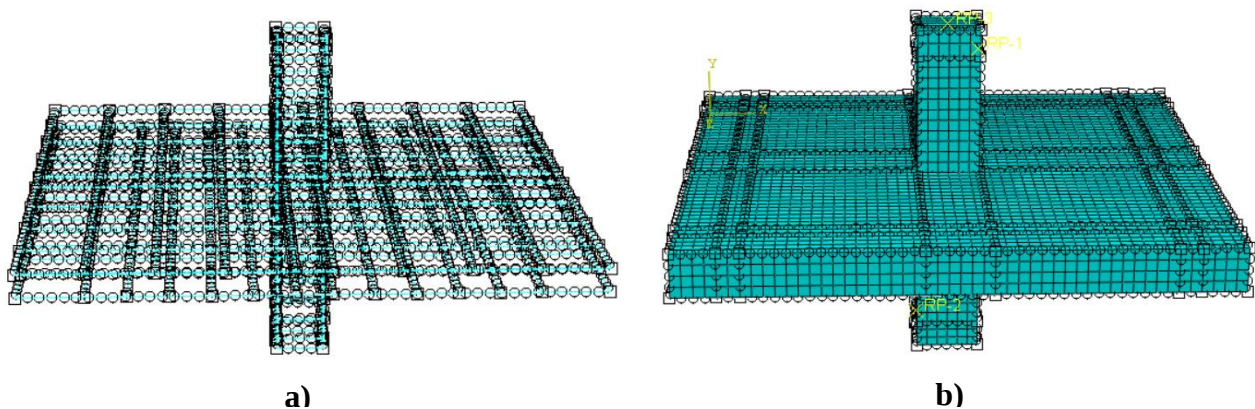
Mallado de los elementos: a) elementos tipo barras (acero de refuerzo) y b) elementos sólidos (concreto).
